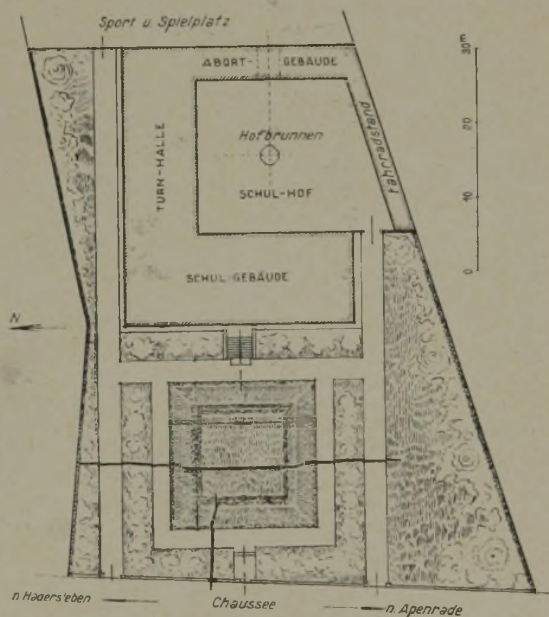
Lageplan. (Maßstab 1 : 1000.)
